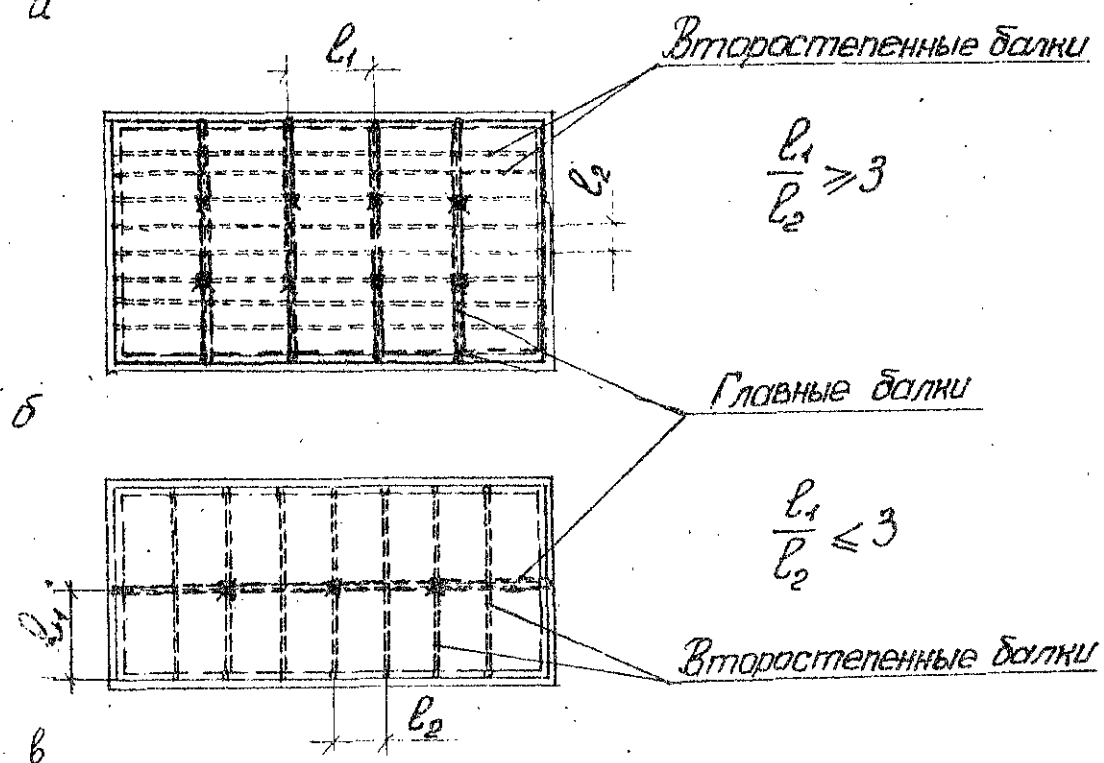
Рис. I. Монолитные ребристые перекрытия: а - фрагмент перекрытия; б - расположение главных балок поперек здания; в - то же вдоль здания
